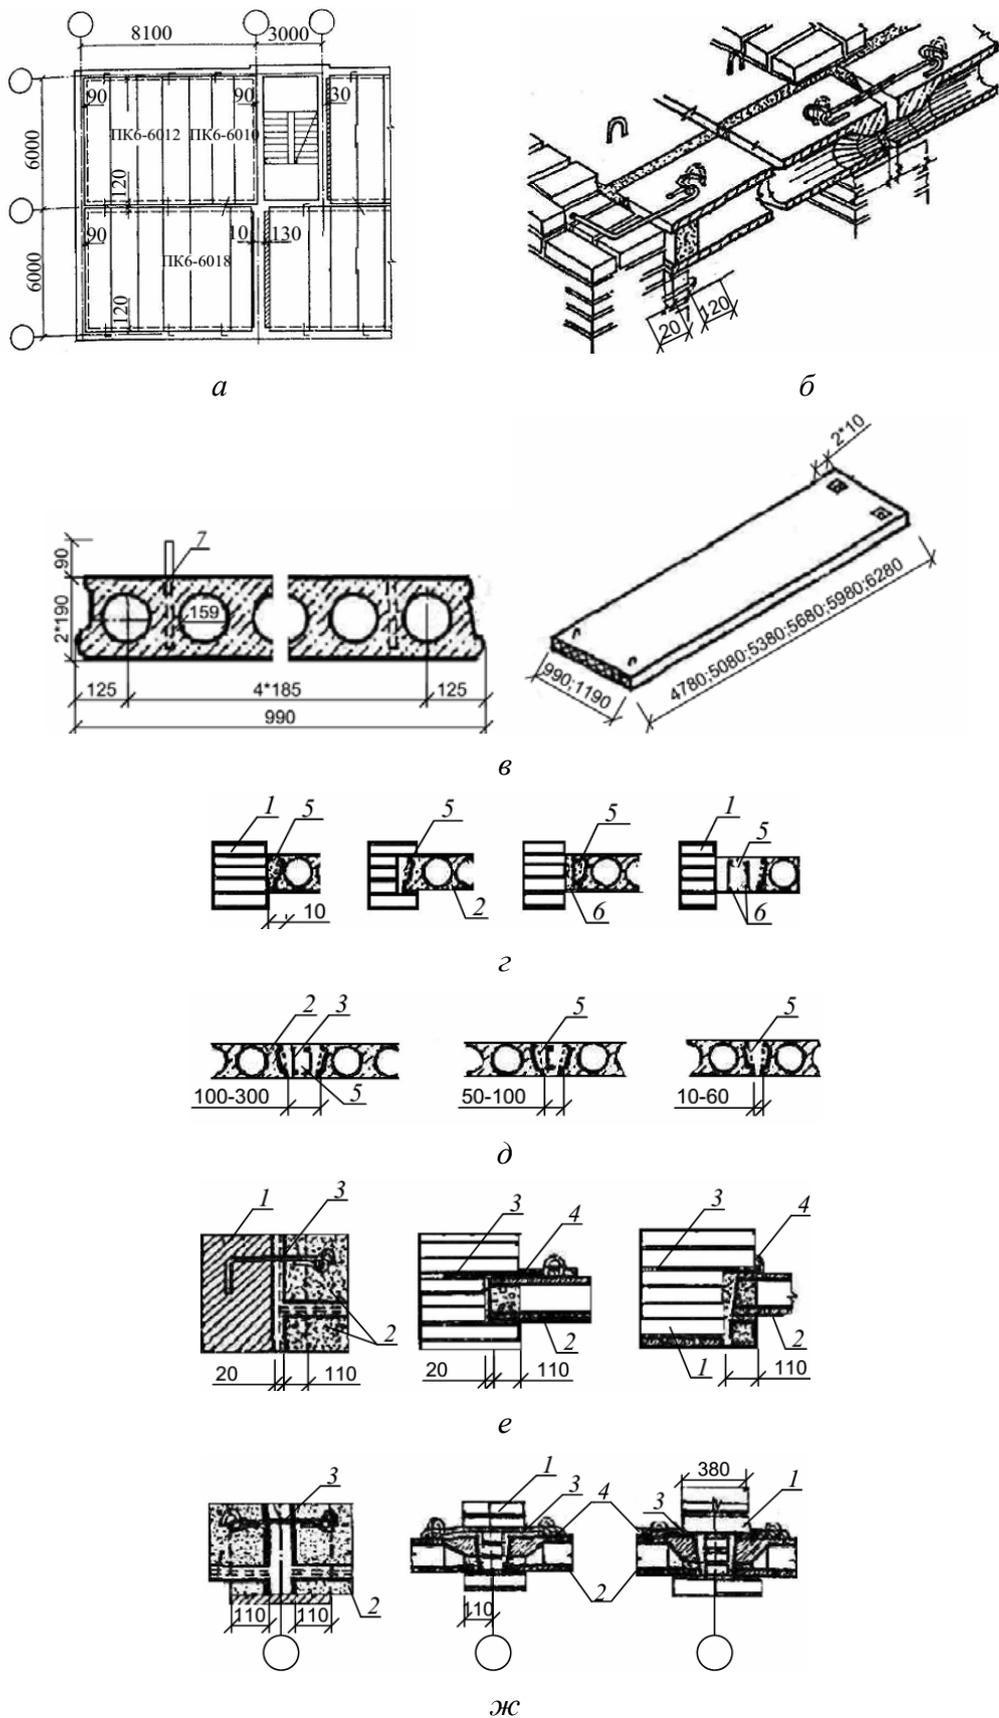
Фрагменты плана плитного перекрытия, узлы: *а* — фрагмент плана перекрытия; *б* — объемный фрагмент конструкций перекрытия; *в* — многоячеечная плита перекрытия; *г* — фрагмент разреза плиты в пристенной области; *д* — фрагмент разреза плиты в середине сечения; *е*, *ж* — фрагменты опор плит на наружную и внутреннюю соответственно: 1 — стена; 2 — перекрытие; 3 — стальной анкер; 4 — цементно-песчаный раствор; 5 — бетон марки М200; 6 — арматурный бетон; 7 — строповочная петля
